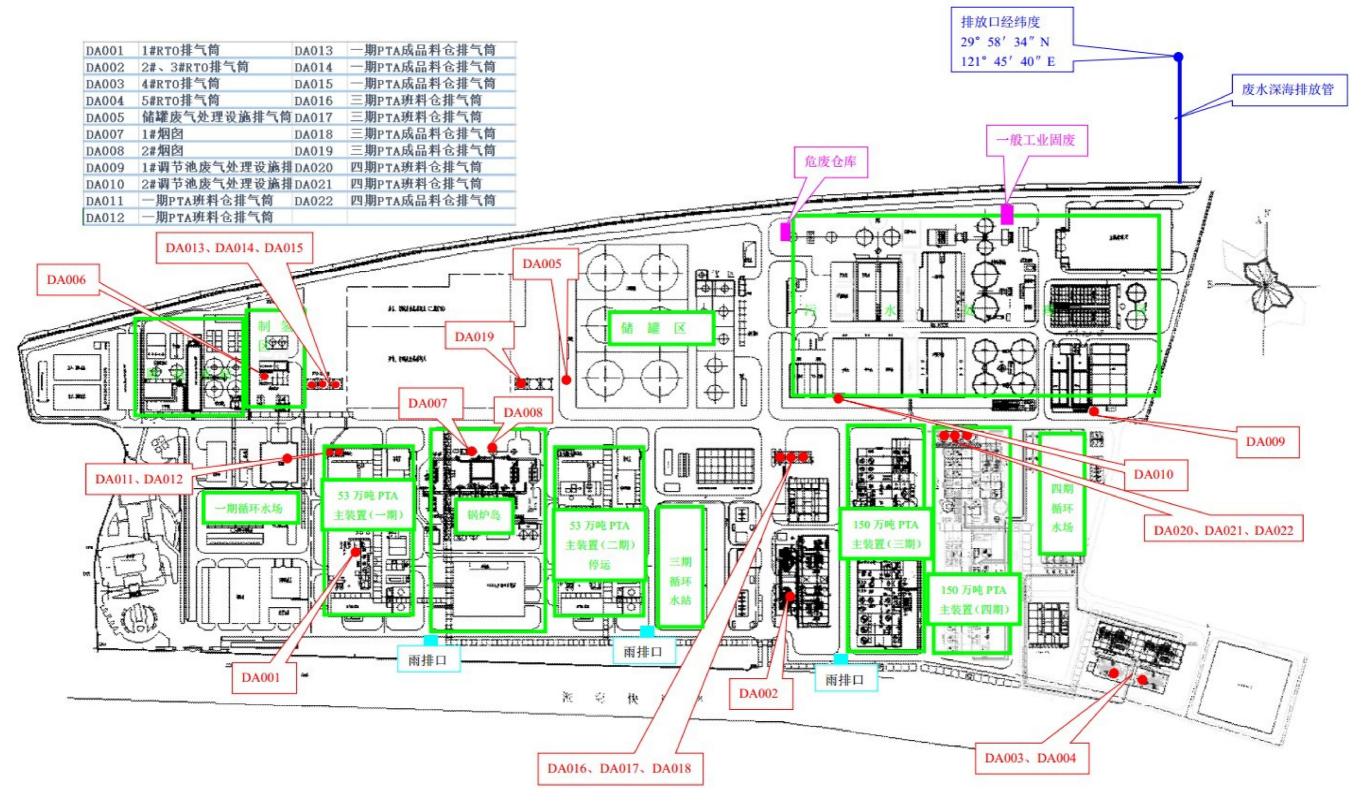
浙江逸盛石化现有工程总平面布置图
